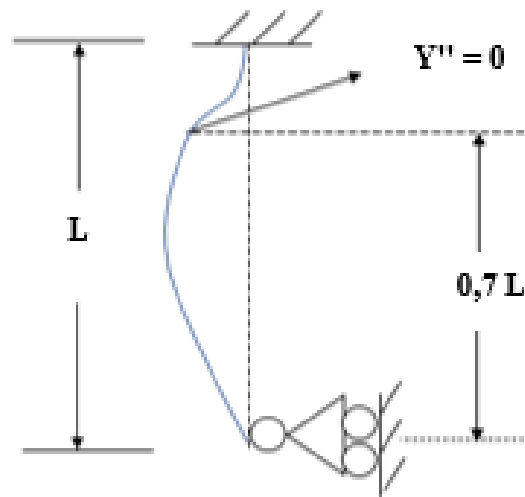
Longitud de pandeo de columna empotrada - apoyada.
